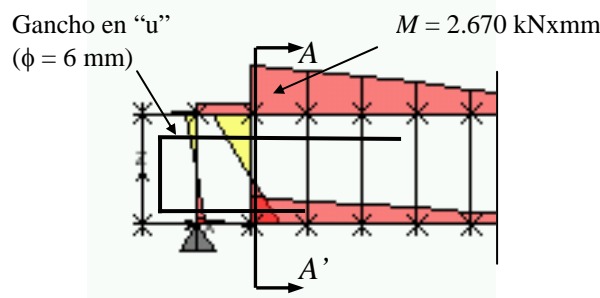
Detalle sección A-A' - Panel 4 EPS 120 mm con zuncho
